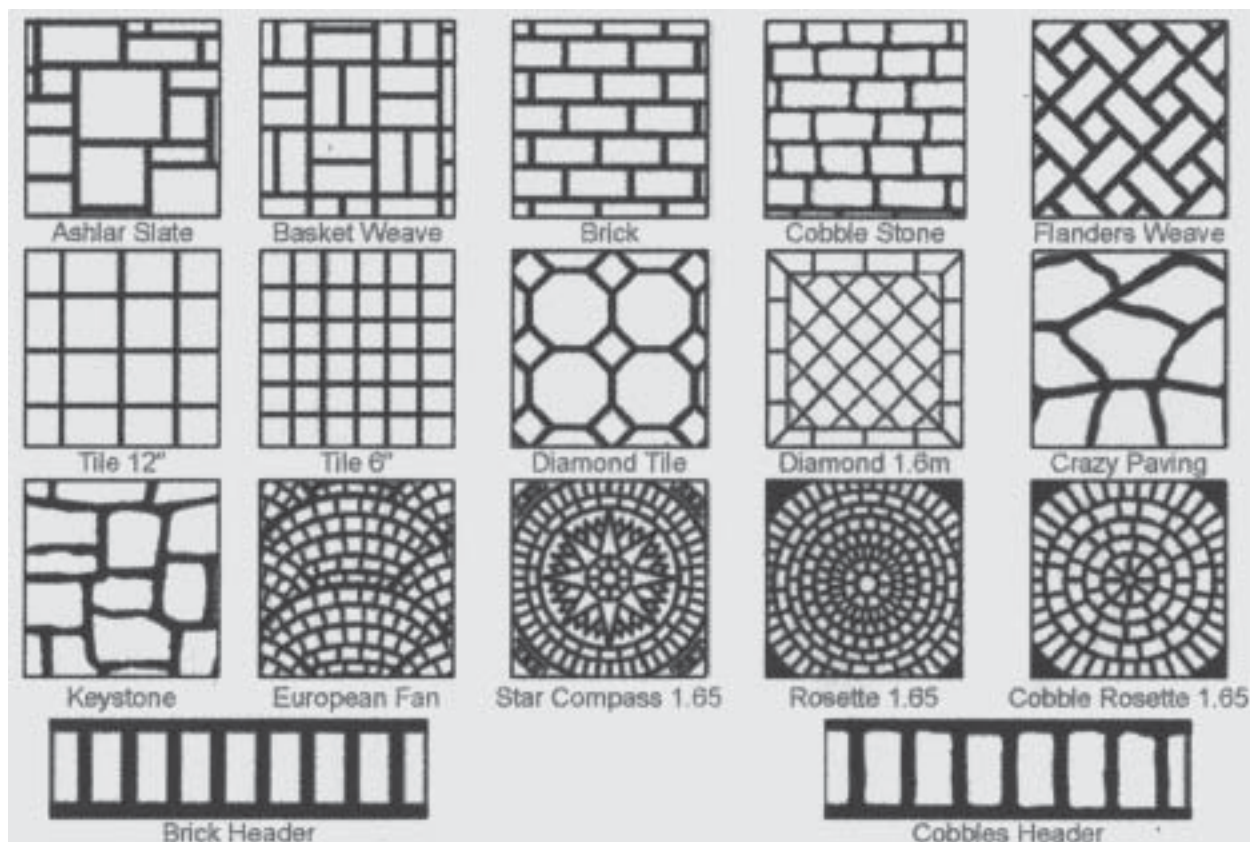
Demonstração da aplicação do padrão de crazy paving na construção civil.
